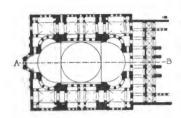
Grundriß-Schema ber bhjant. Rirche.
